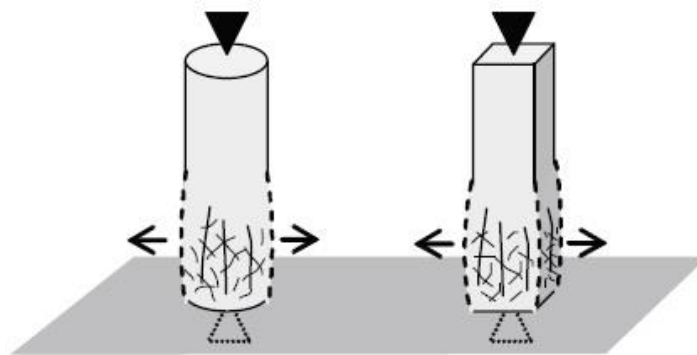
Padrão típico de fissuração de colunas esmagadas:
